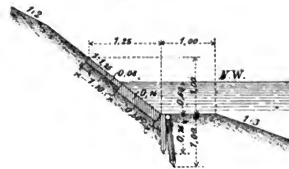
Uferbefestigung mit Zementplatten. M. 1 : 80.
